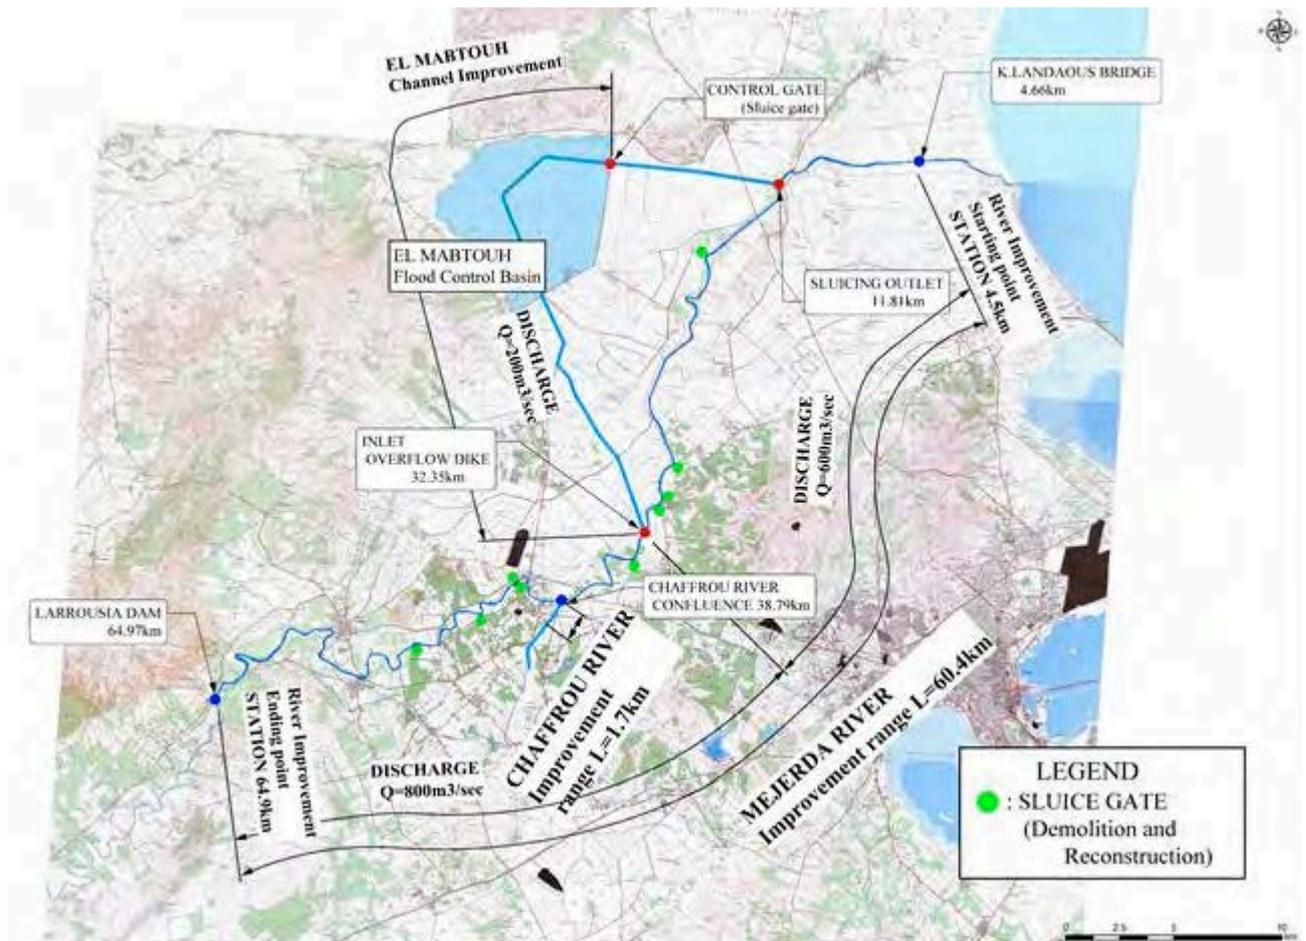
Plan d'ensemble de la zone d'amélioration
